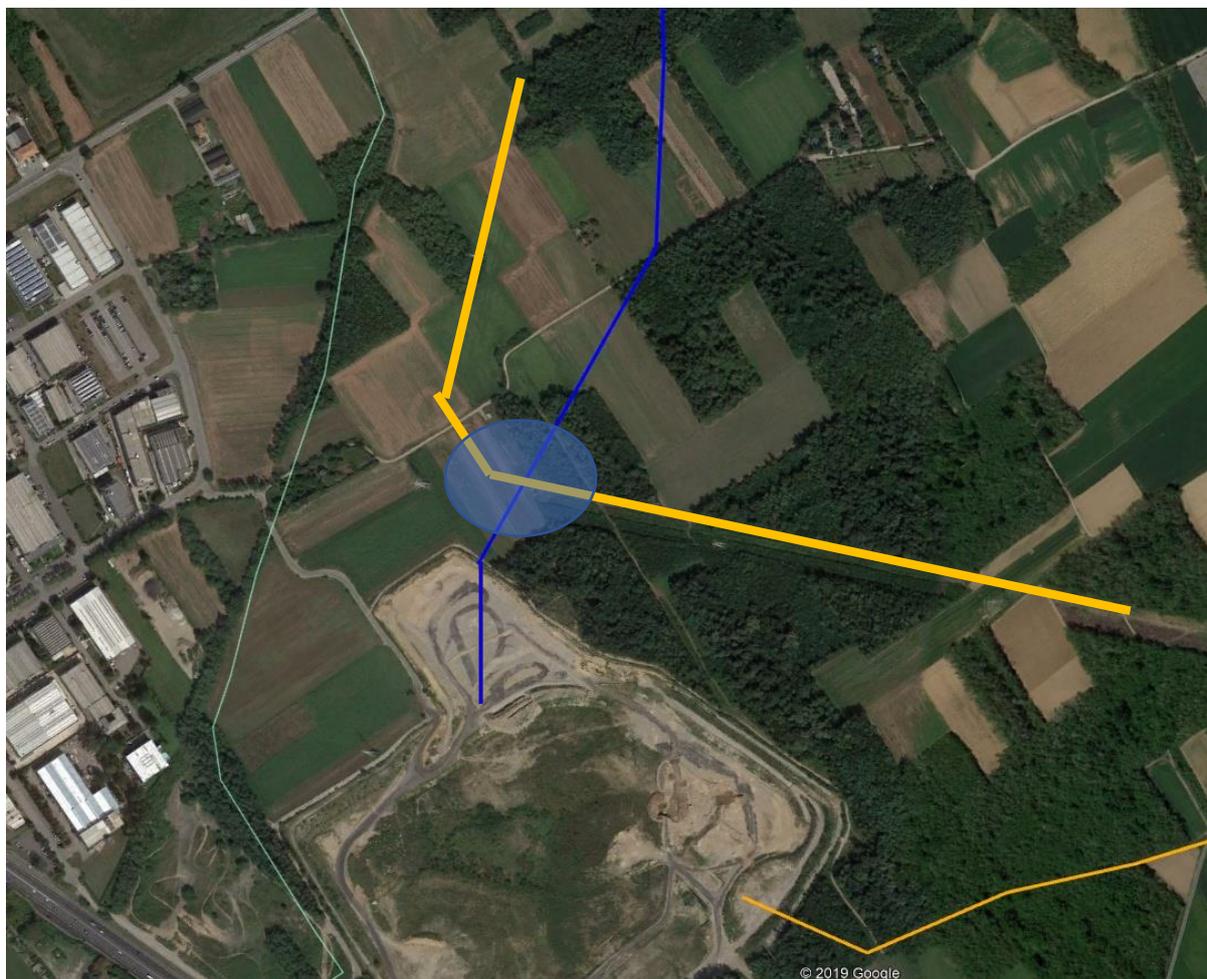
individuazione planimetria dell'intersezione tra canale di progetto (colore blu) e gasdotto SNAM (colore arancio)
